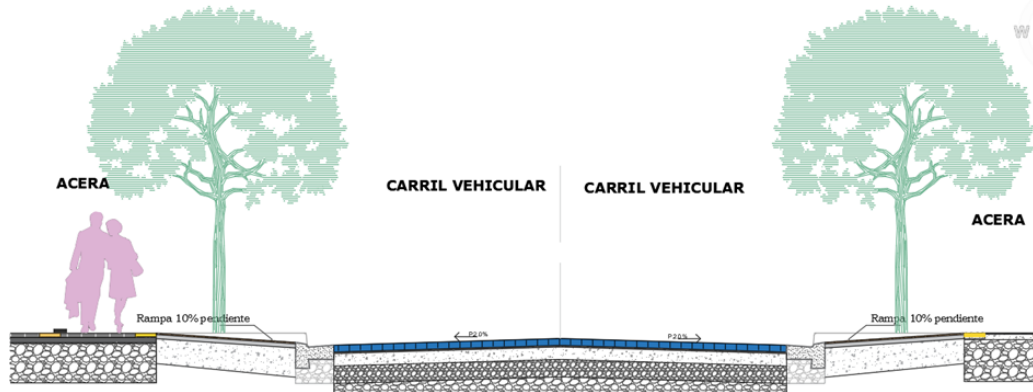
Perfil vial más rampas y accesos. Elaboración: Propia.
